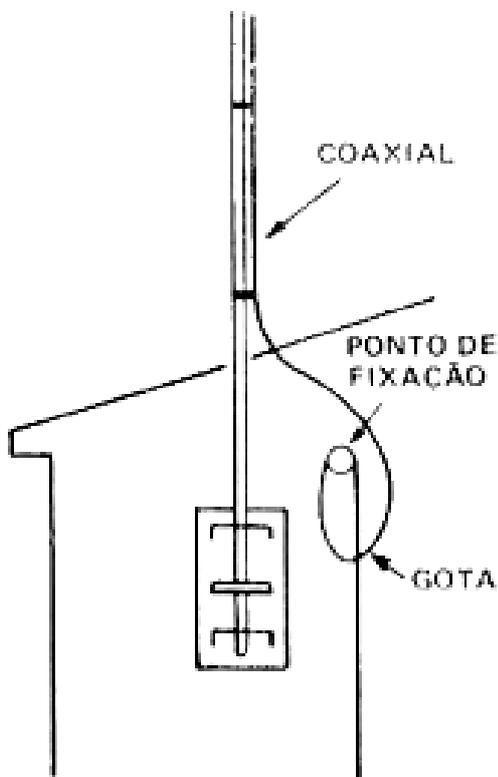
Fixação do cabo coaxial junto ao rotor: deve ser deixada uma volta (“gota”) de cabo para compensar a rotação da antena.
